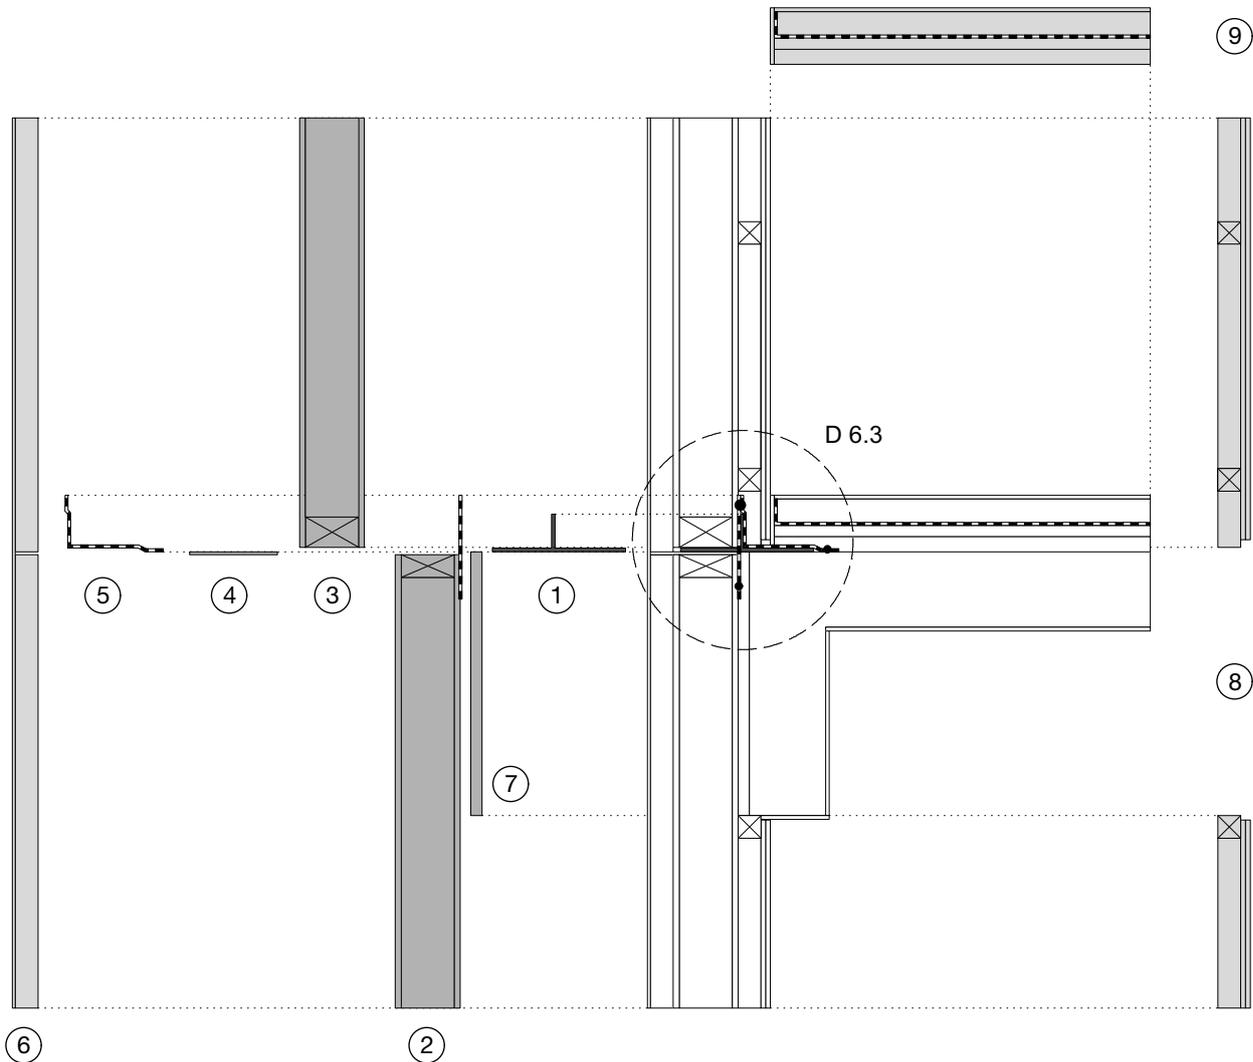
Montagereihenfolge - Anschluss Geschossdecke mit Randunterzug - Außenwand, vorgestellt
